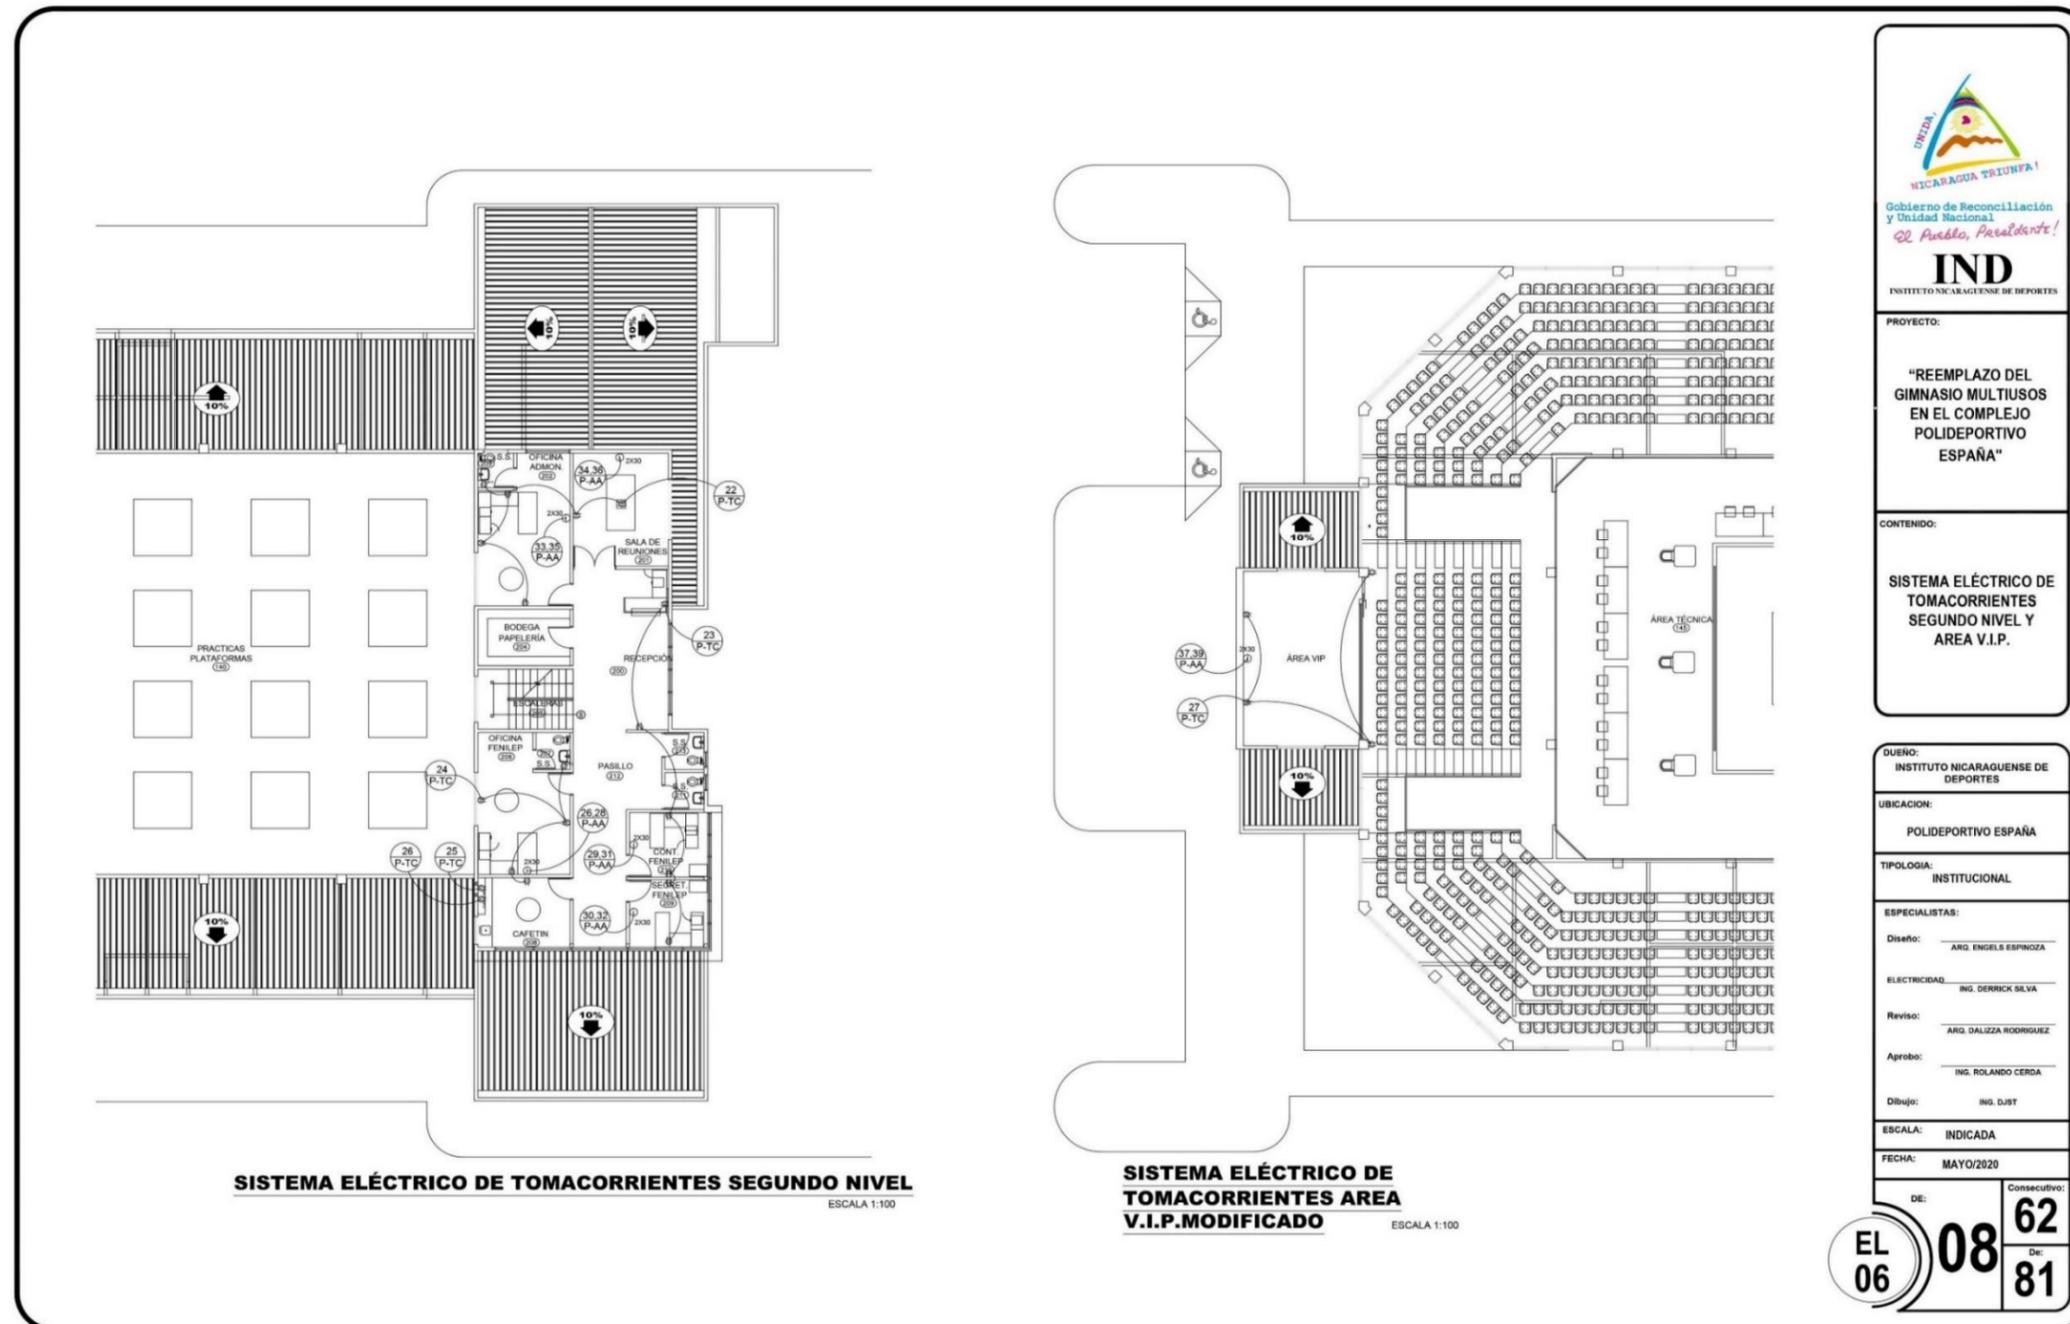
Planos de sistema eléctrico y tomacorrientes del segundo nivel y area de VIP, modificado por la Practicante
